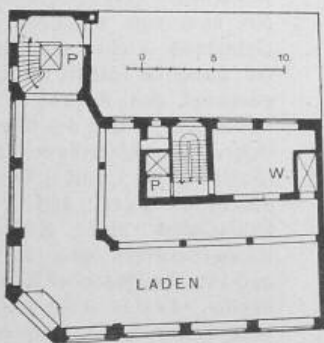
Erdgeschoss-Grundriss. 1:500.
